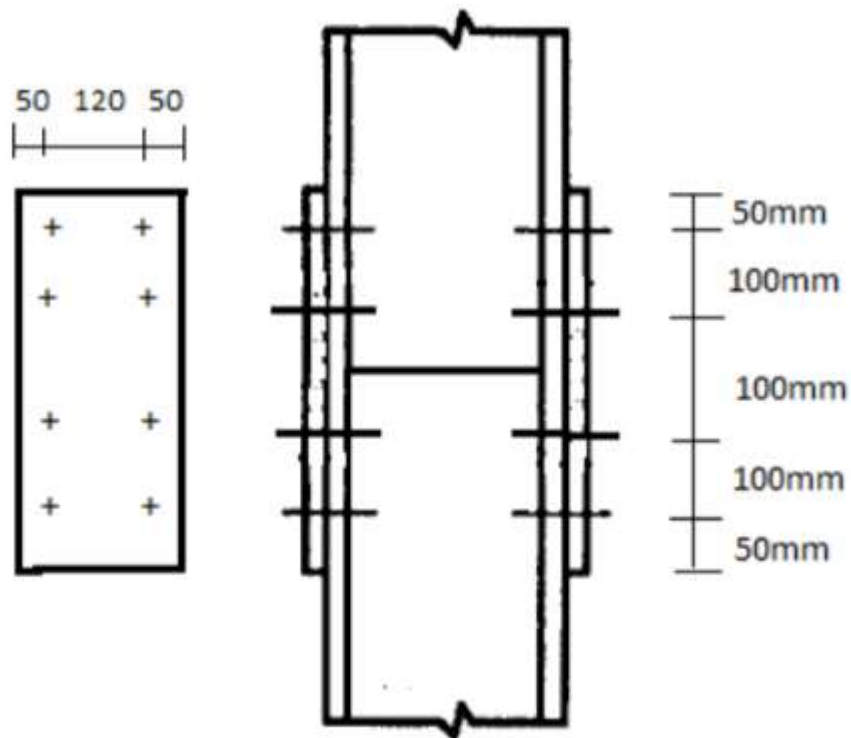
assemblage poteau-poteau (couvre-joint de la semelle)
